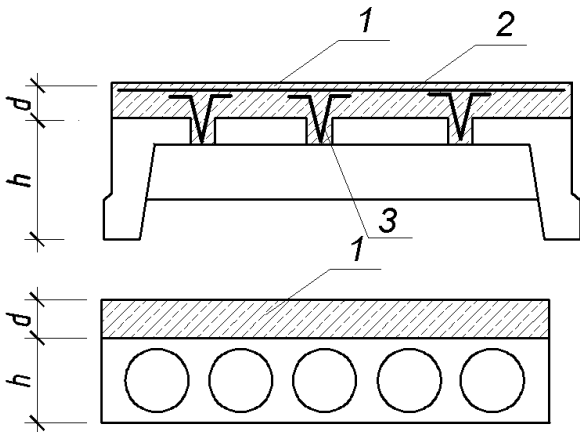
Підсилення плит нарощуванням стиснутої зони:
